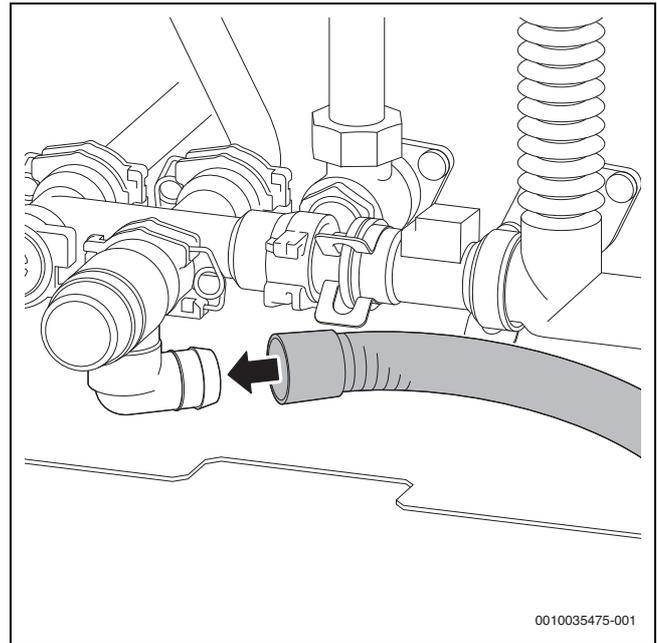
Montage du tube sur la soupape de sécurité (circuit ECS)
